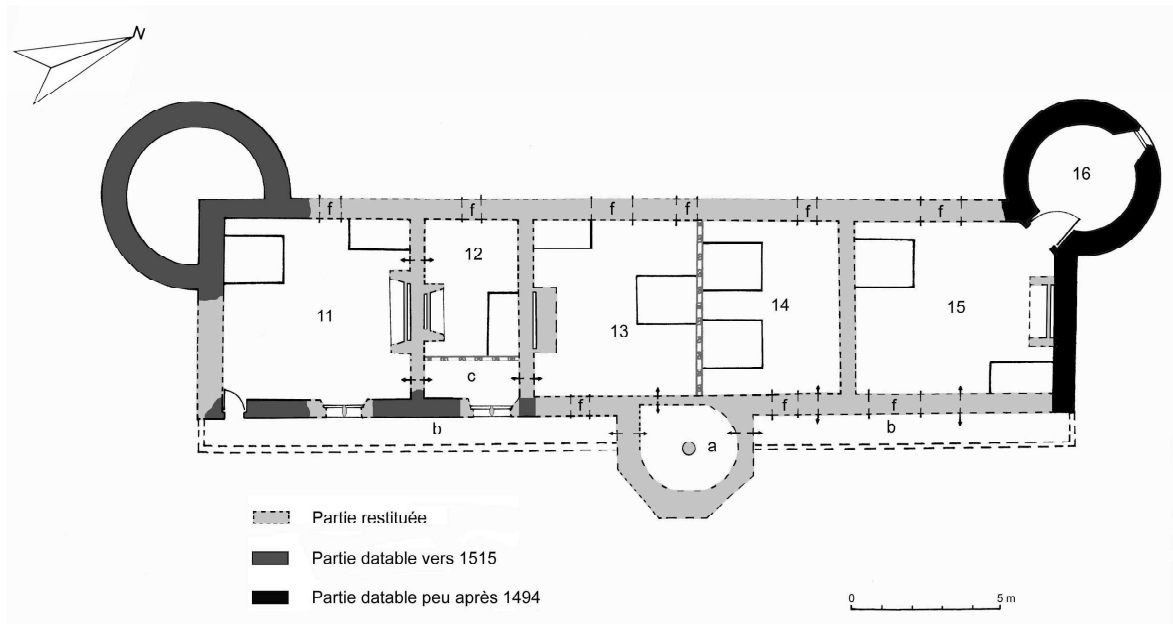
Houlbec. Plan restitué du premier étage en 1603 (voir : Volume III, Document n° 21).
